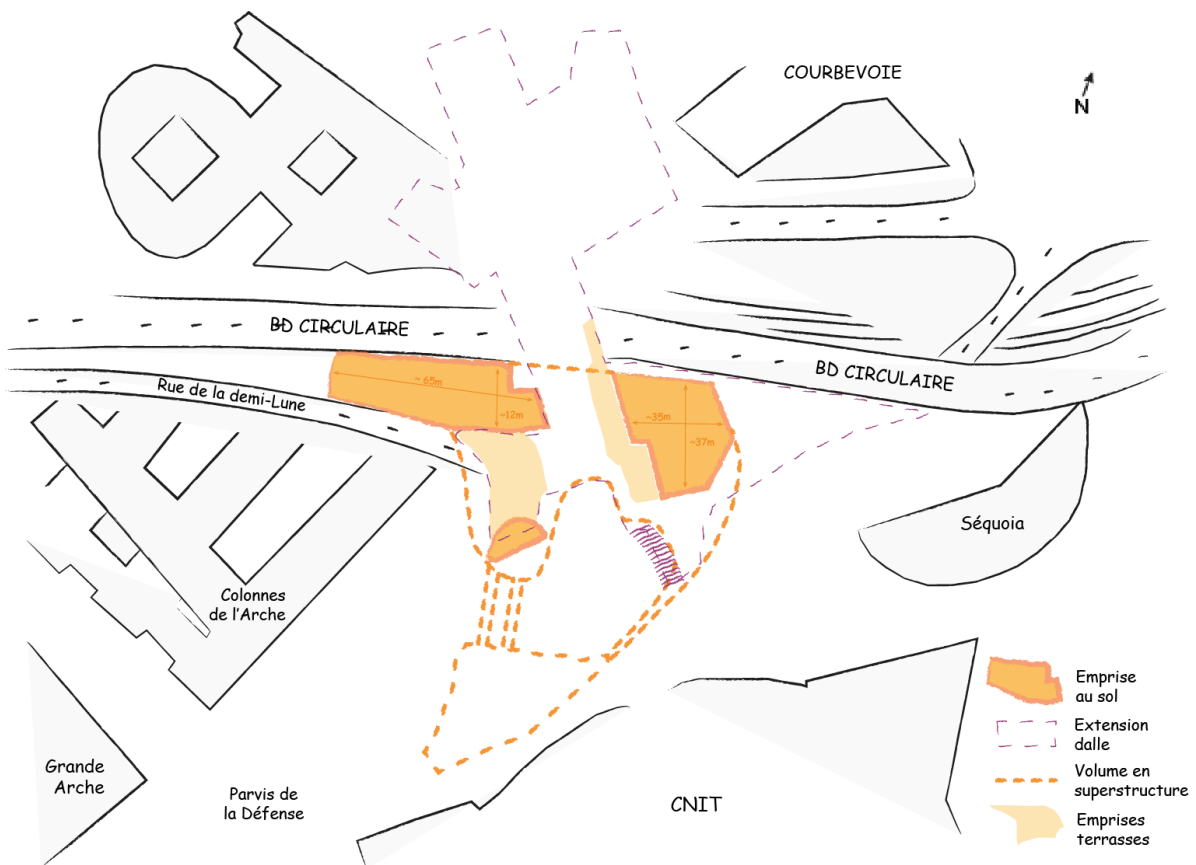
Emprise au sol du projet Phare : emprise bâtie, extension de la dalle et constructions en superstructure (crédit : auteur)
